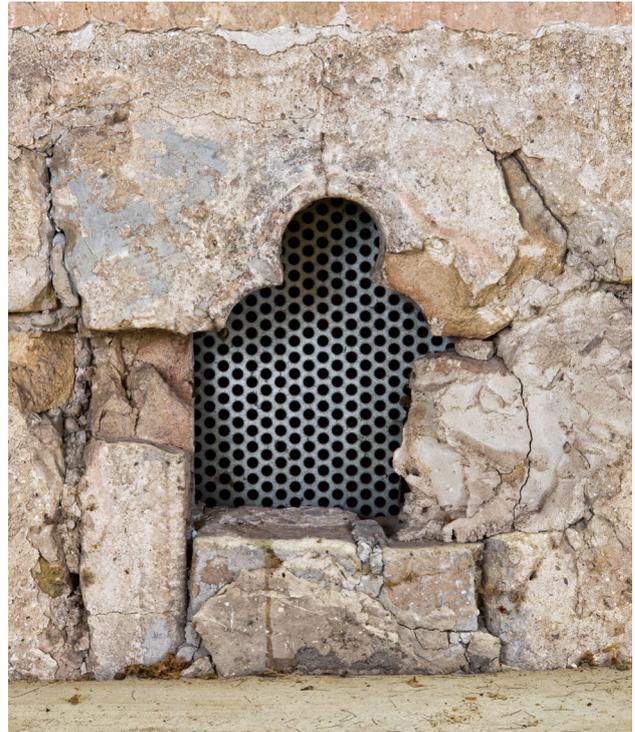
Orth an der Donau, Schloss. Nordwestturm. Südfassade im Dachgeschoß des Westtrakts mit Dreipassfenster, vermutlich um 1334.
